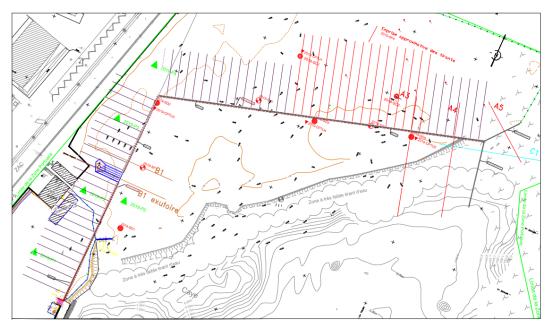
vue en plan du quai (palplanches et tirants) (source : Ginger Géode)
